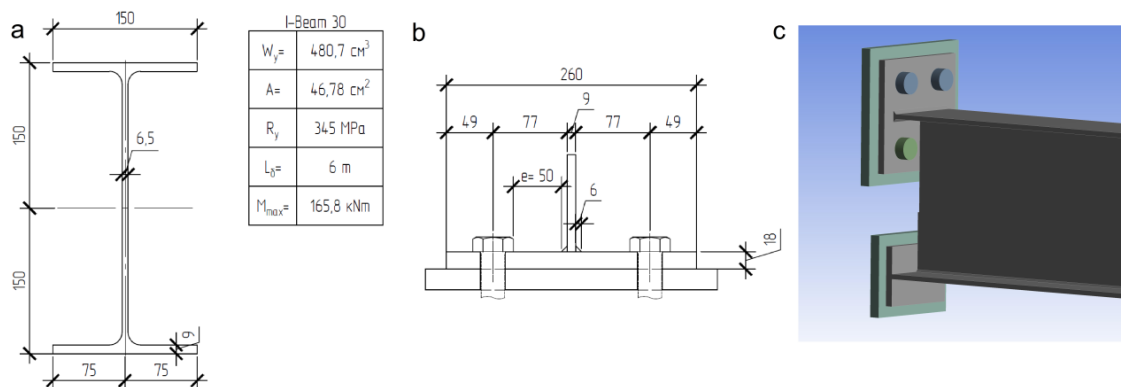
Модельная балка: а) поперечное сечение ; б) принятое Т-образное соединение; с) расчетная схема податливого узла
